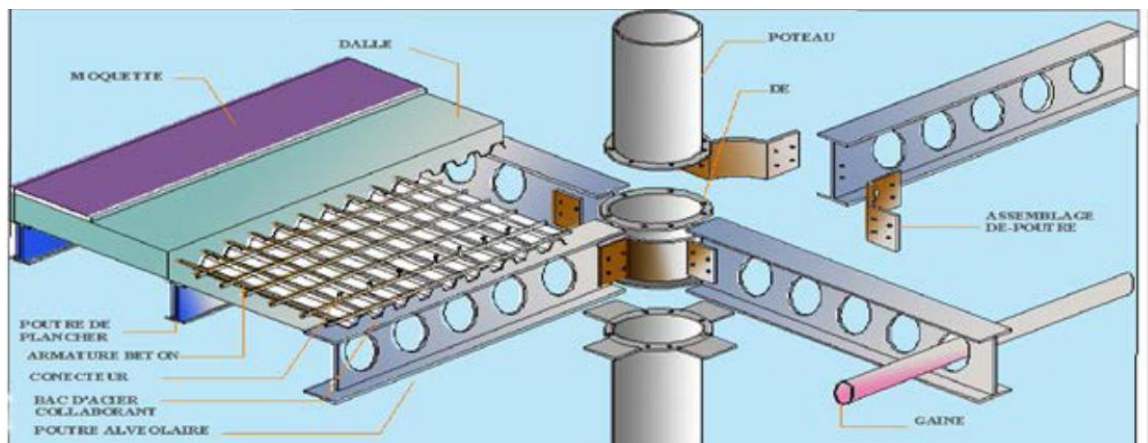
Détail de jonction (Poteau, Poutre, plancher).
